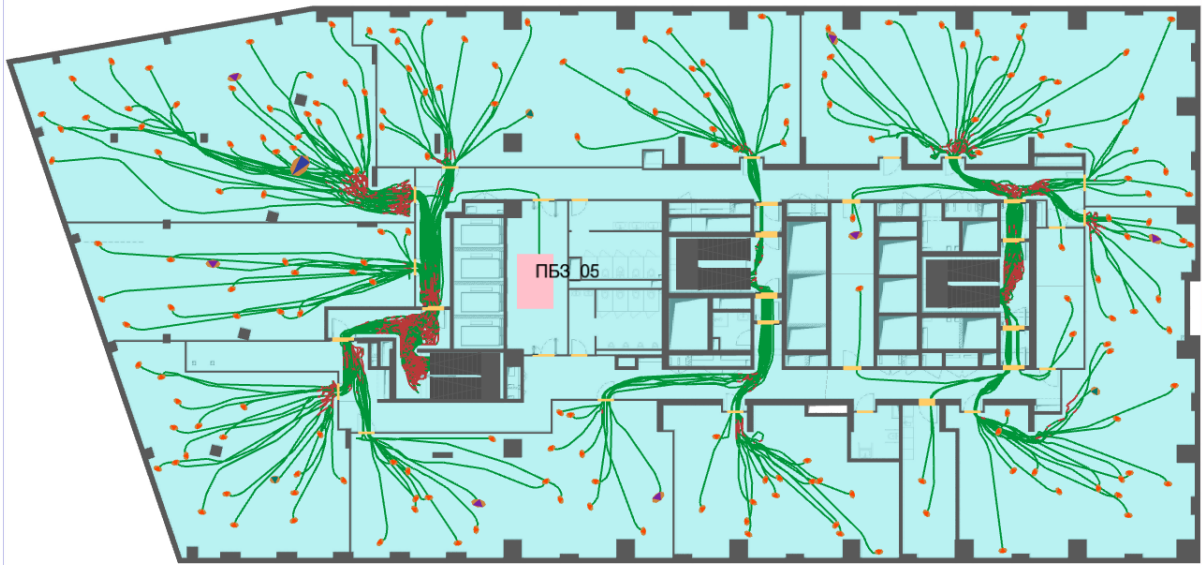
План 5-го этажа и нанесенная на него расчетная (принципиальная) схема эвакуации
